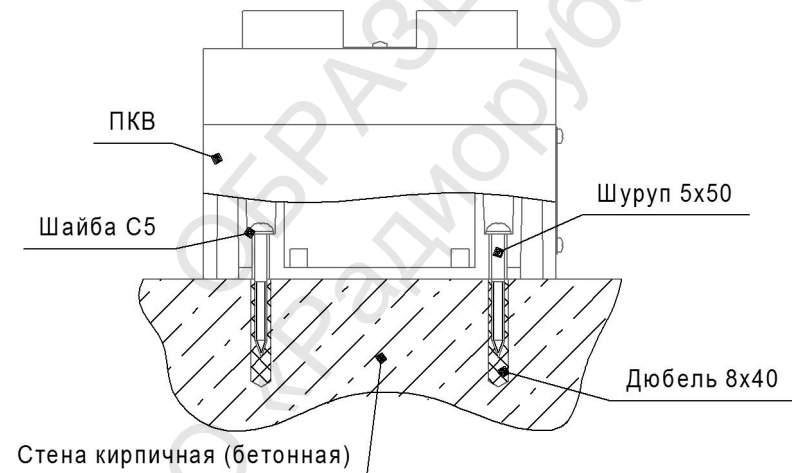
Монтаж изделия на кирпичную или бетонную стену
